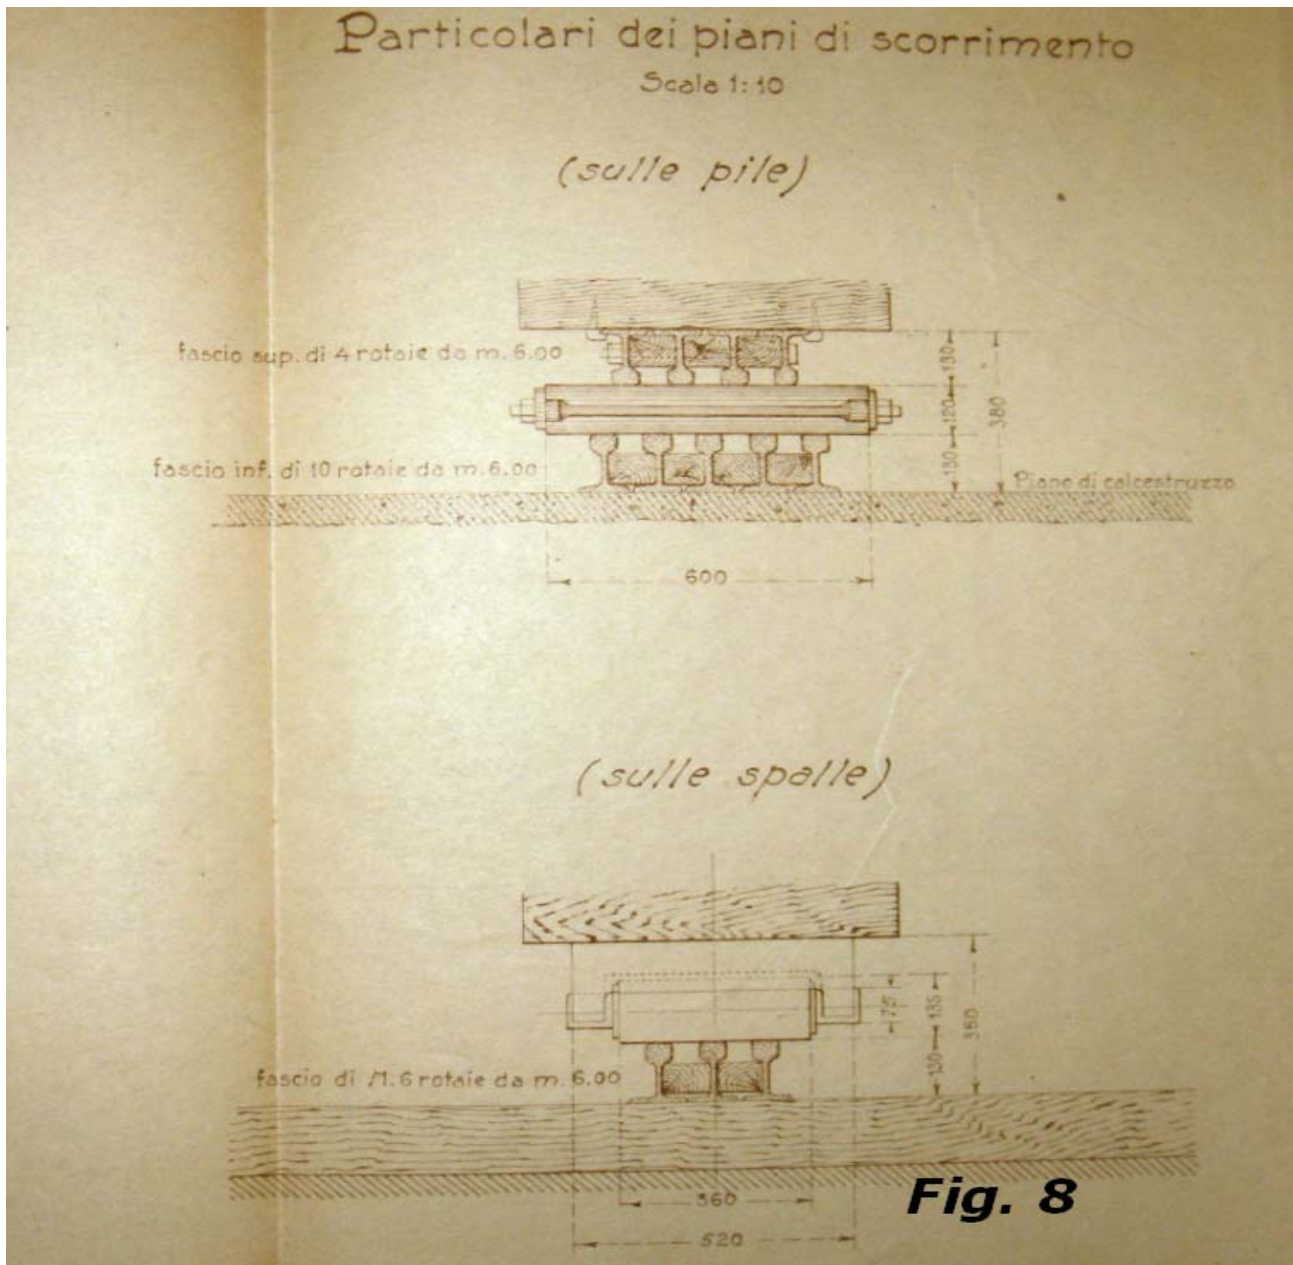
Dettagli degli apparecchi destinati a favorire lo scorrimento laterale delle travate metalliche su pile e spalle avventizie. Come si nota, gli apparecchi montati sulle spalle differivano da quelli montati sulle pile.
